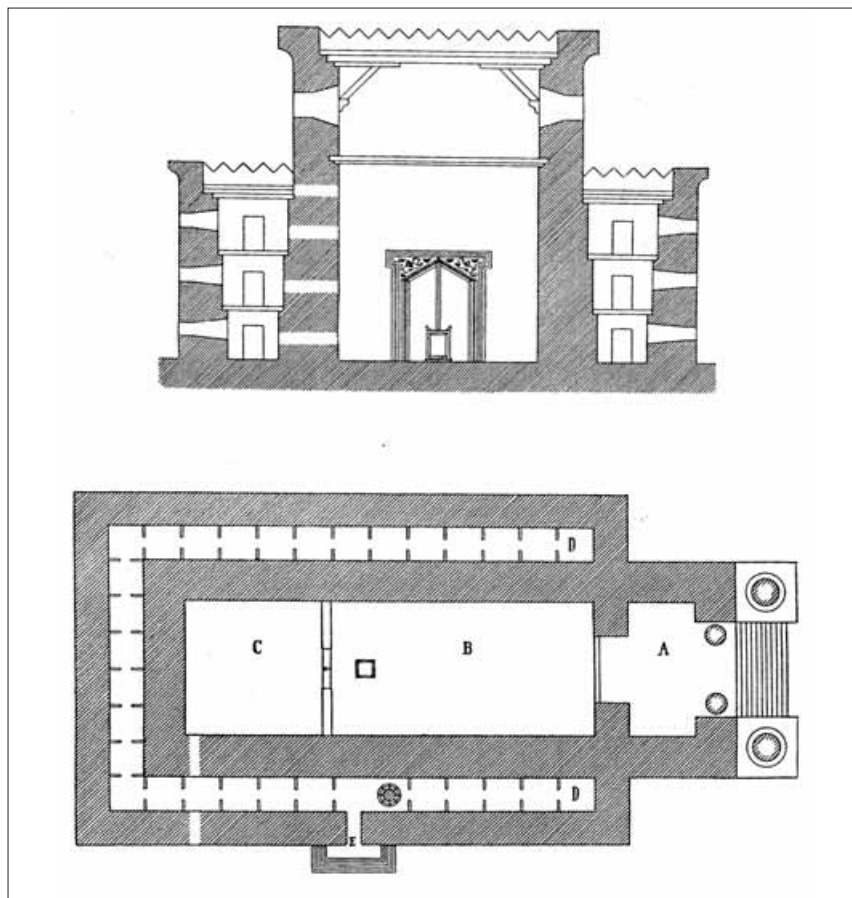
Corte transversal y planta del templo de Salomón en Jerusalem.
